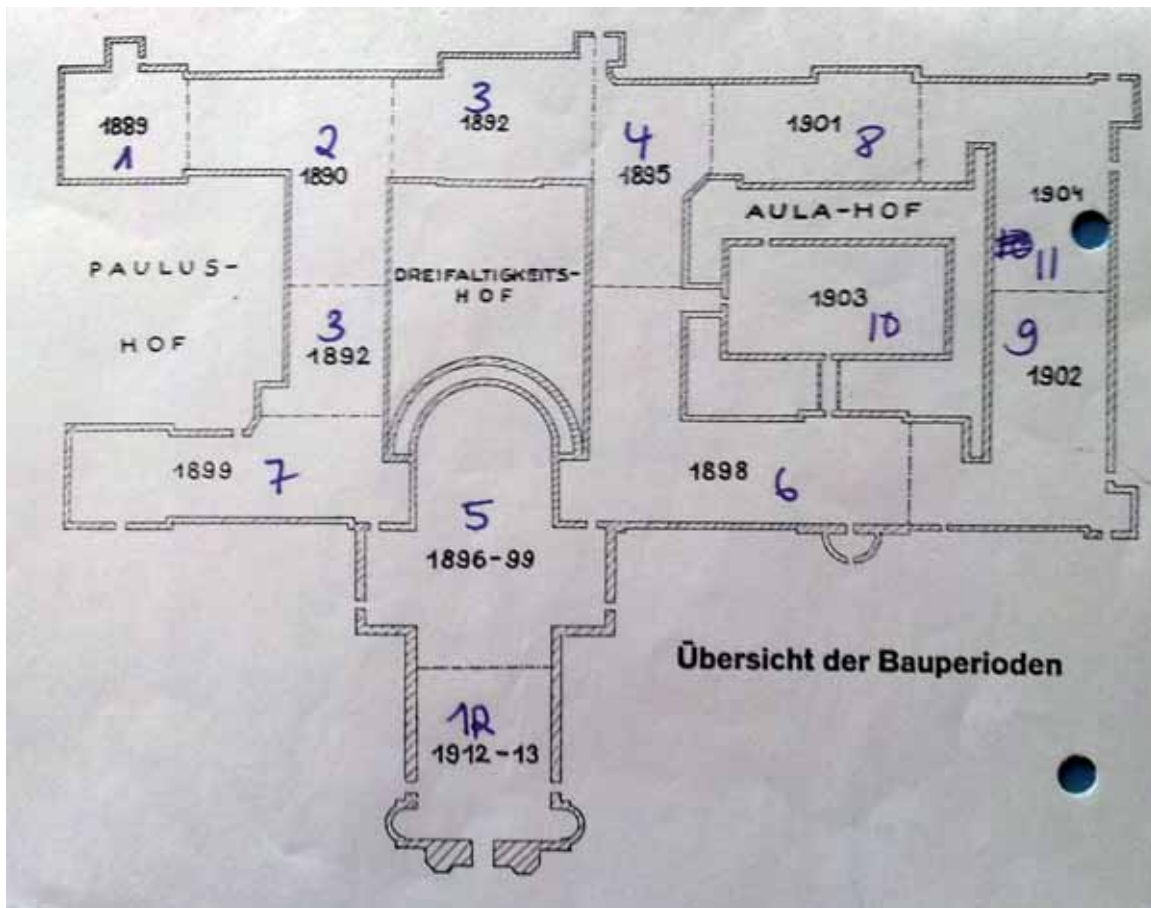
Vereinfachter Gesamtlageplan St. Gabriel
